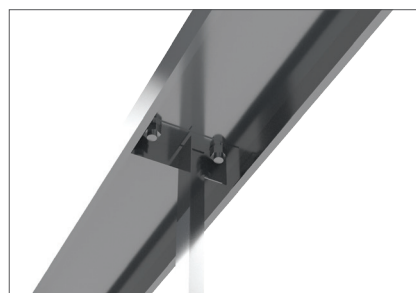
Szczegóły profilu obramowania okna połączzonego za pomocą kątownika (TC). Obowiązuje ta sama zasada, co w przypadku obramowania drzwi.
